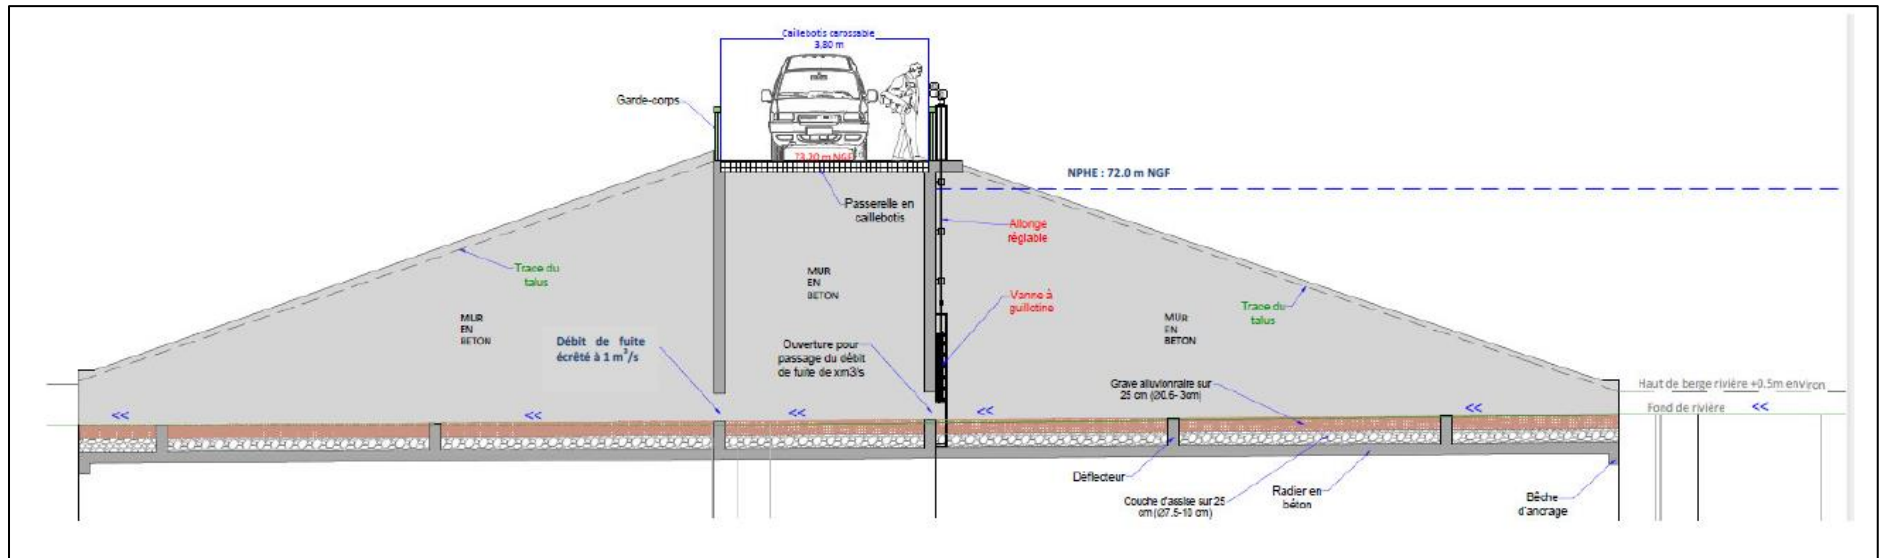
Coupe type de l'ouvrage de Beaugies, section lit mineur (Source AVP Antea)
